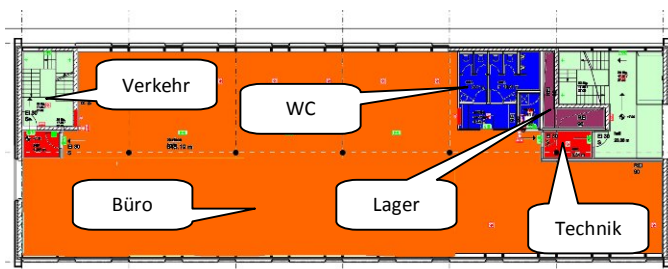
Grundriss Regelgeschoss mit Zonierung, Geb.7
